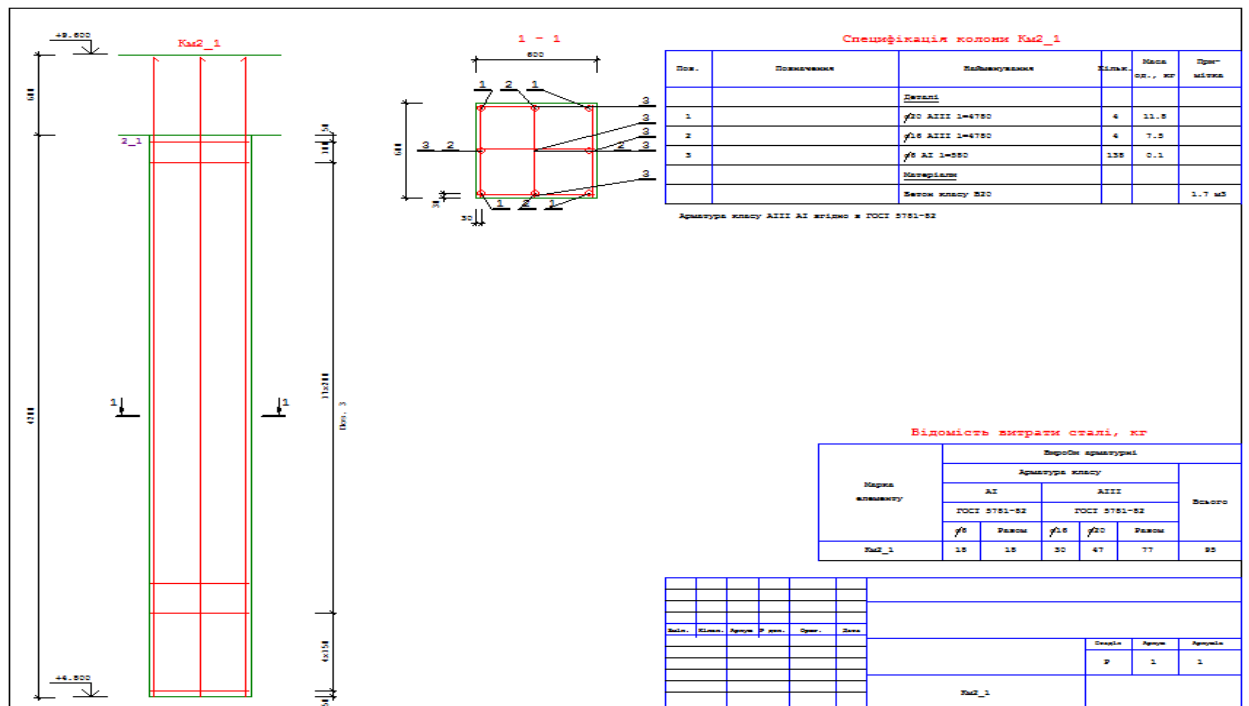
Варіант будівлі з балочно - плитним перекриттям. Колона К2-1. Креслення робочого проекту.
